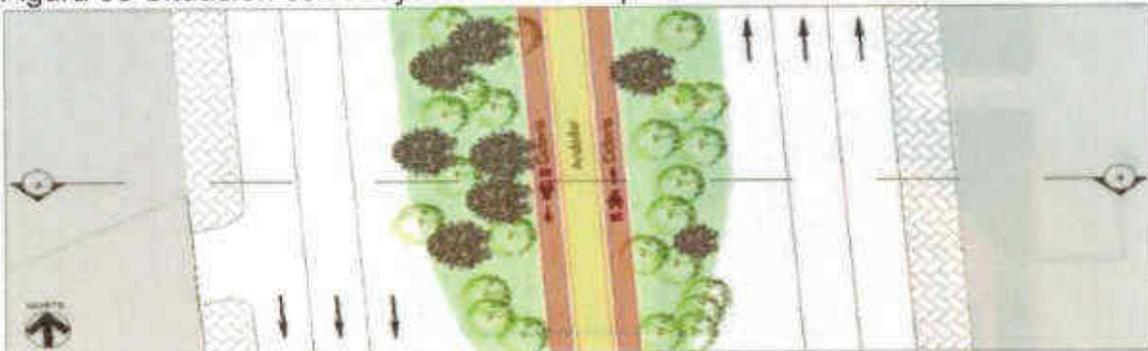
Situación con Proyecto; Corte de planta de la Av. 20 de Noviembre.
